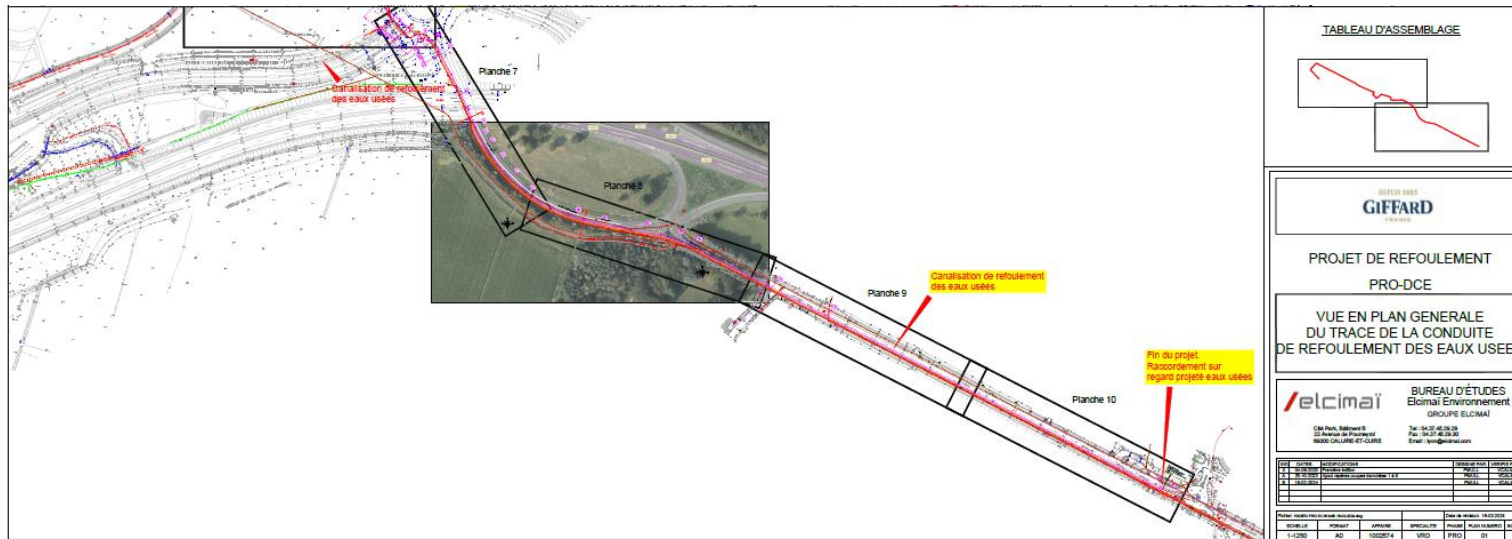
Vue en plan du tracé du projet de conduite de refoulement - Planche 1 (Source : Elcimai Environnement - PRO)
